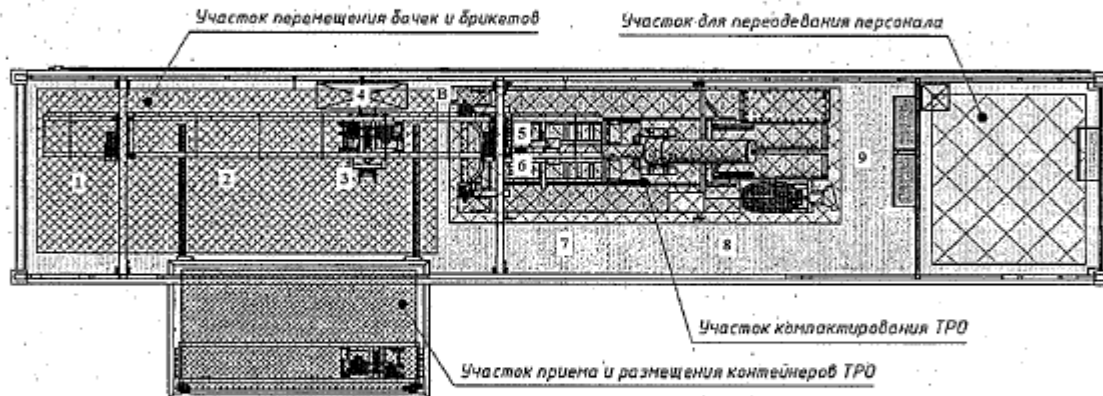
Схема и точки контроля на площадке хранения ОНАО
